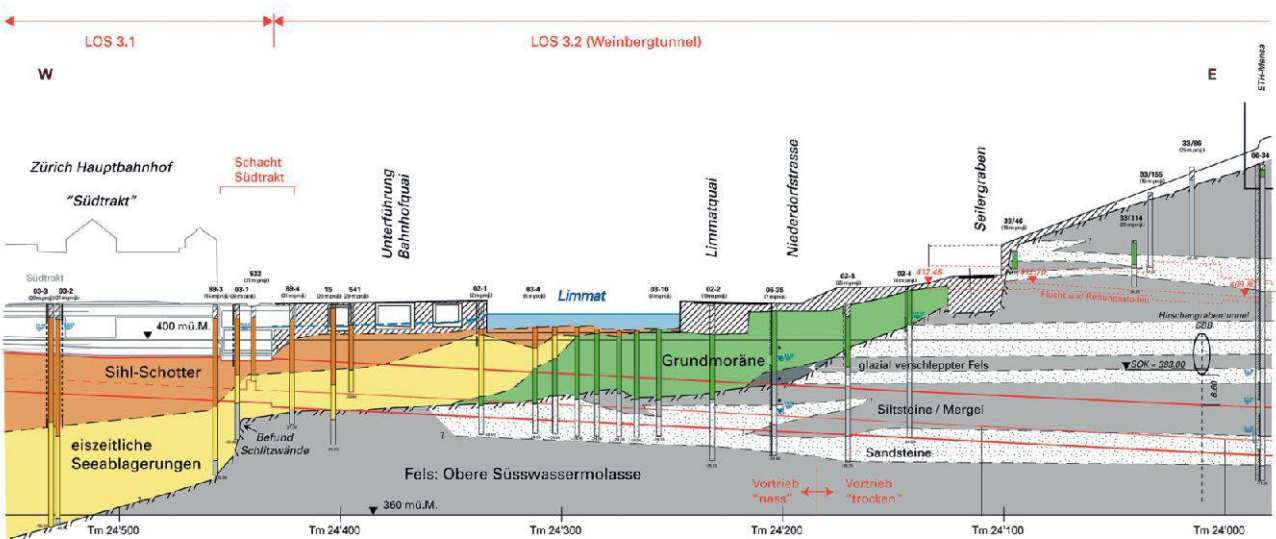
Weinbergtunnel: Geologisches Längenprofil Abschnitt Central (rechts) bis Schacht Südtrakt beim Hauptbahnhof Zürich (Projektstand Ausschreibungsunterlagen), 2-fach überhöht.
